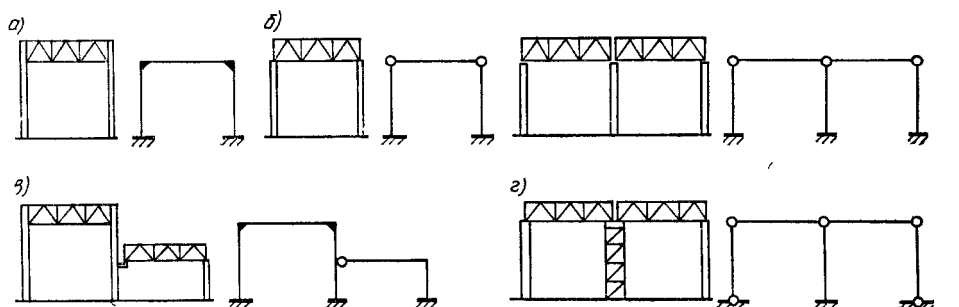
Виды сопряжения ригеля с колонной и расчетные схемы поперечных рам
